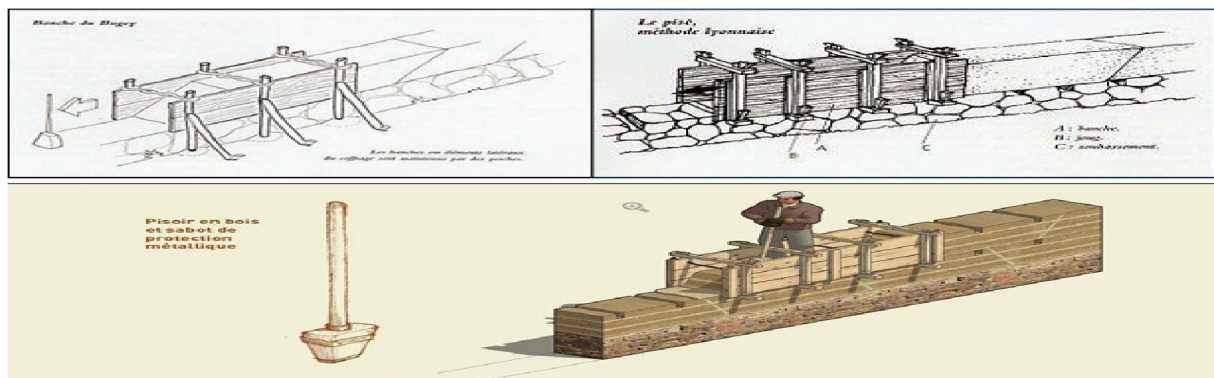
construction un mur en pisé (HAMZA A. Z., 2017)
